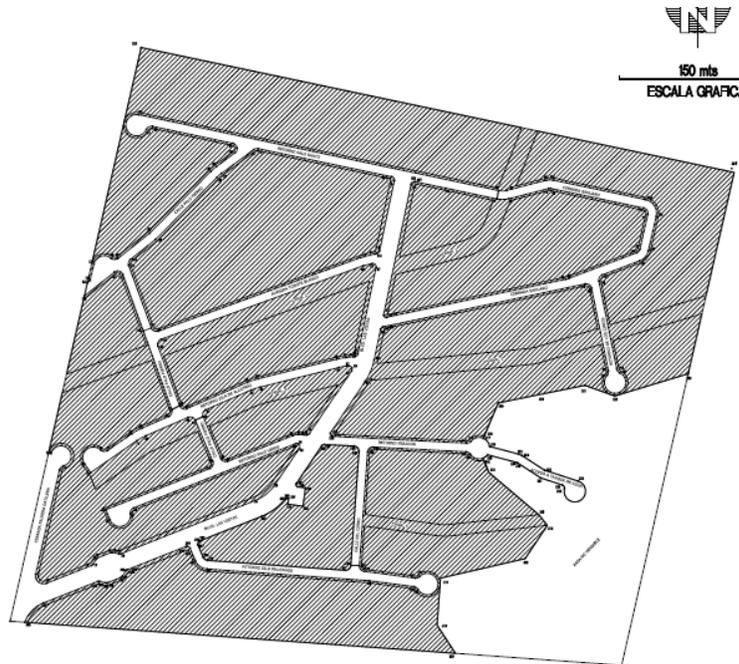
Lotes, canales pluviales, y área de equipamiento a incluir dentro de las 21-70-07.61ha de la Ampliación de Vistas Reserva Residencial
